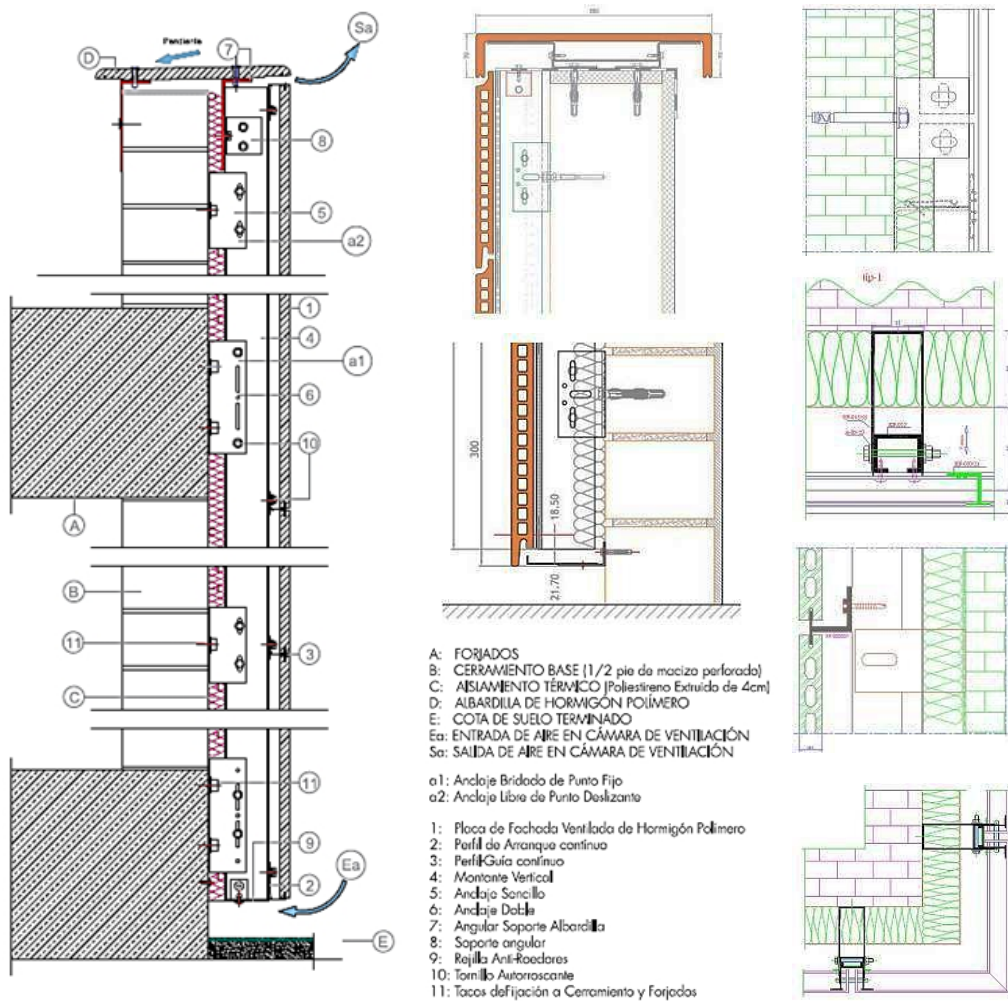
Ejemplo de esquema constructivo de fachada ventilada ligera de hoja exterior colgada con fijaciones a la hoja interior
